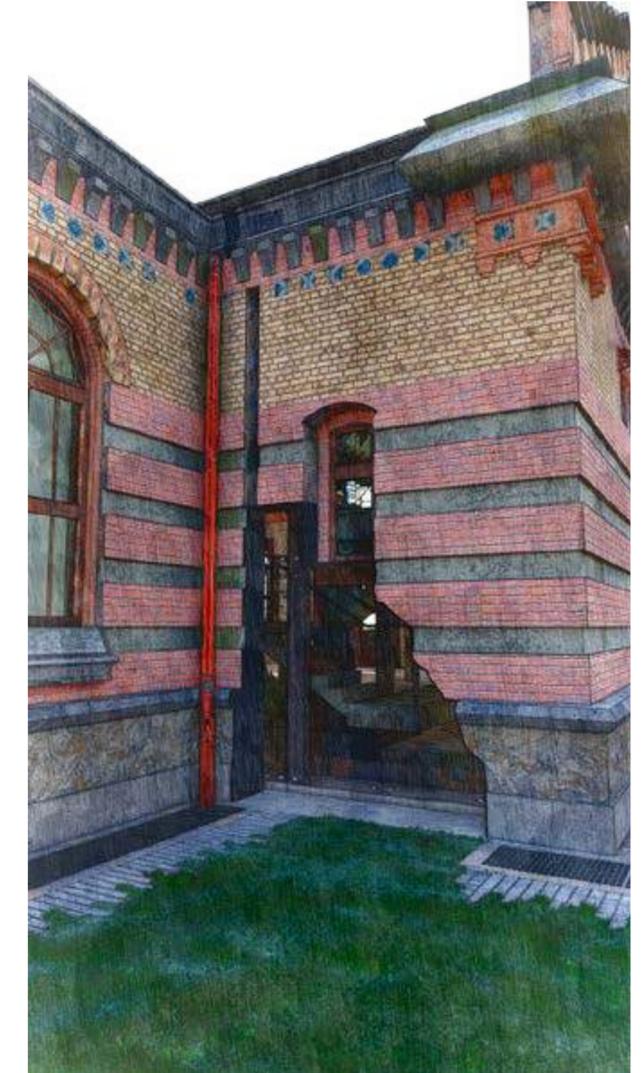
Vista ilustrada - Consolidación fachada Norte. Producción personal - MRPE.
